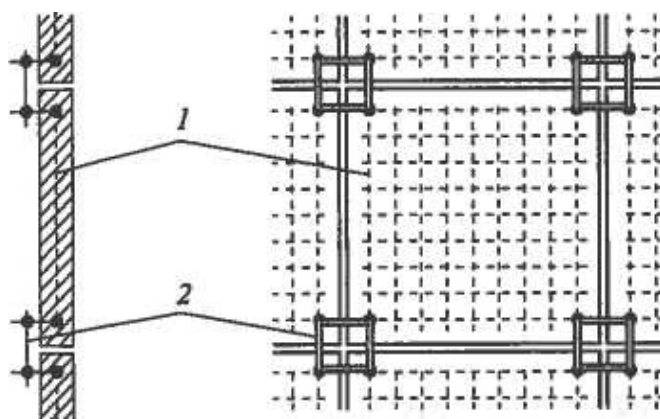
Монтаж соединительных проводов на плитах из предварительно напряженного железобетона с помощью сварки или болтовых соединений:
